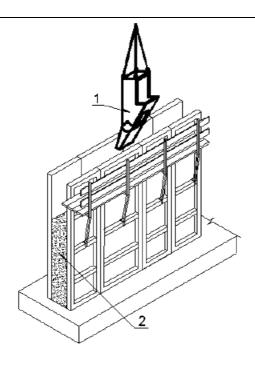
Укладка бетонной смеси в конструкцию по системе "кран-бадья"
